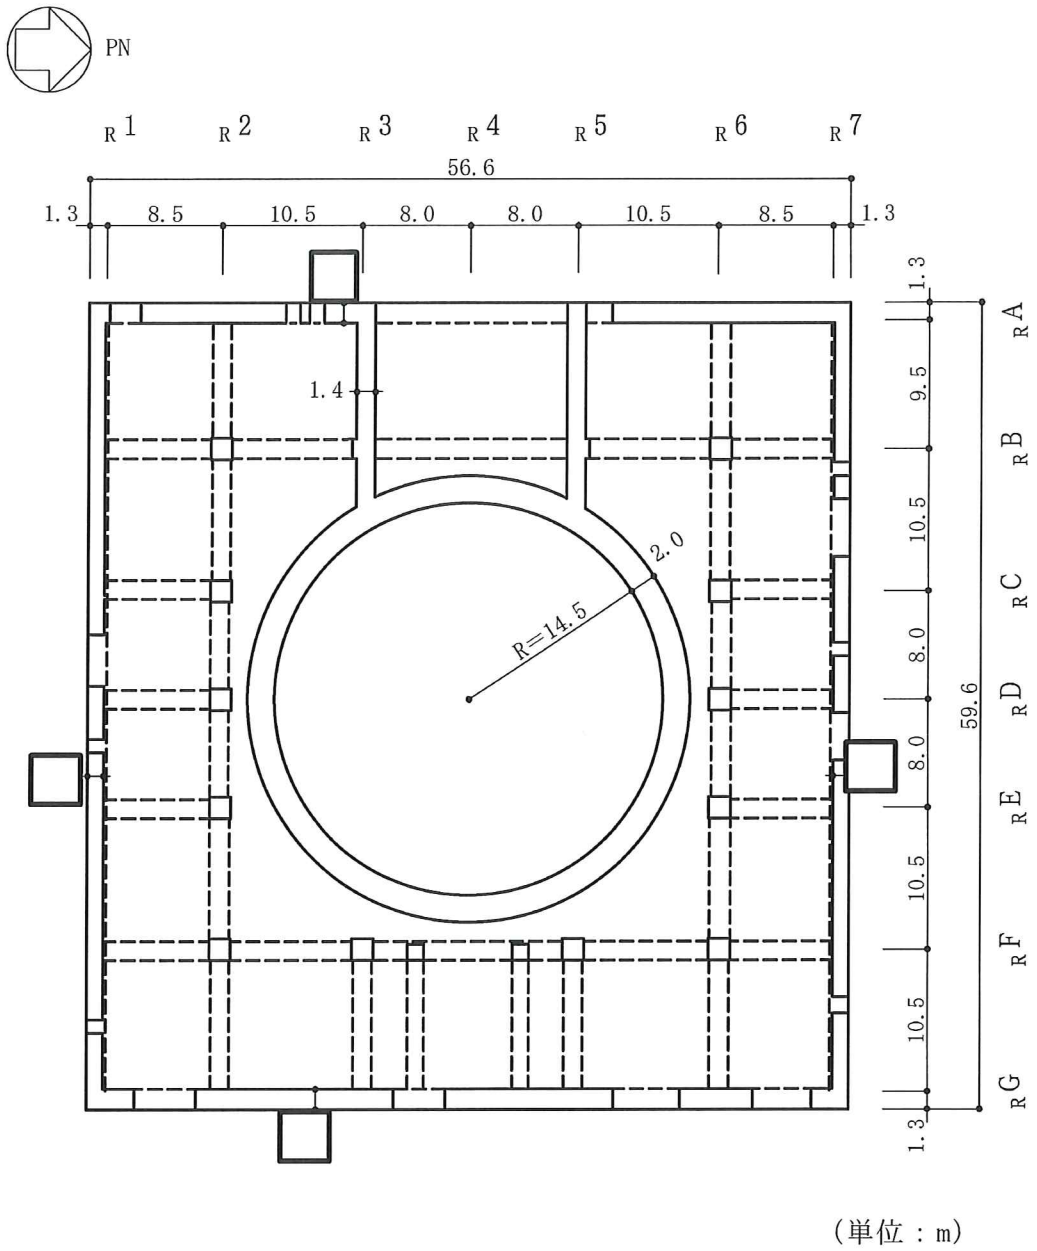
6号機原子炉建屋の概略平面図 (1F, T.M.S.L. 12.3m) (4/9)
